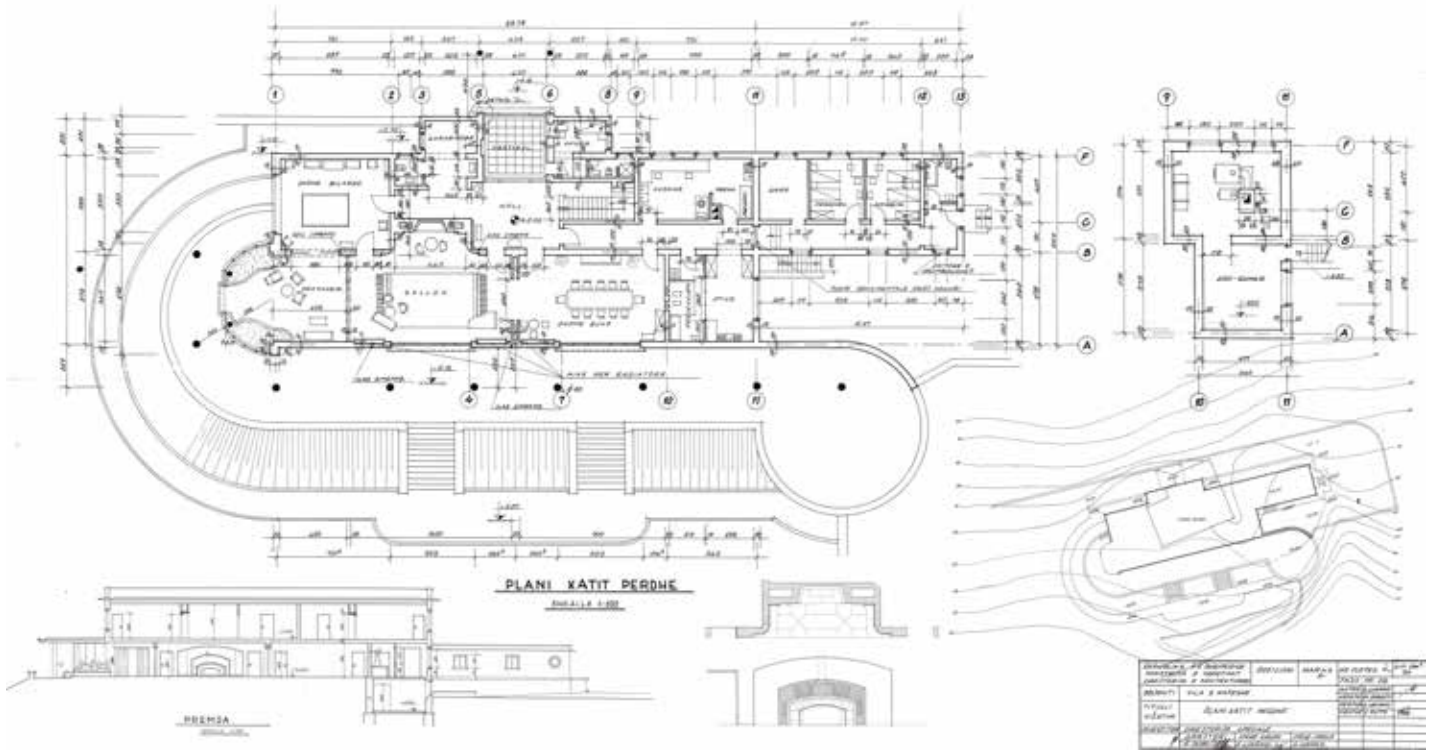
Skënder Luarasi, Villa in Cold Springs, Vlorë, 1964, unbuilt, construction documents, site and floor plan (TCAC)
